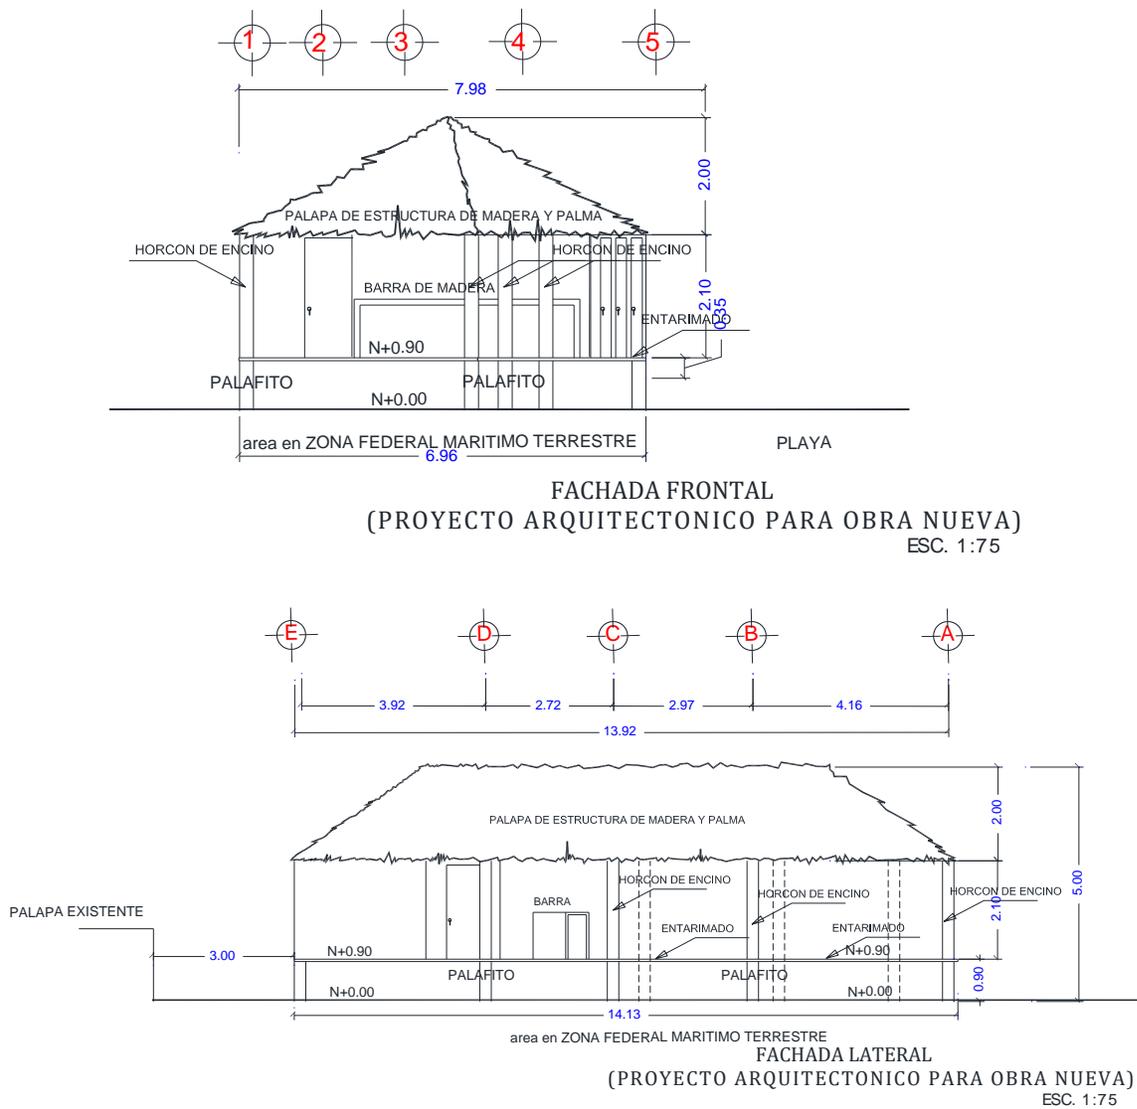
Fachadas de la obra. (alzado del nivel del suelo, 0.80 m. tipo palafito)
